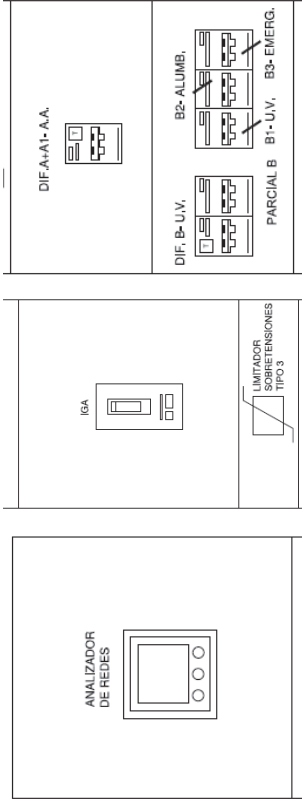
Esquema Unifilar Tipo Cuadro Eléctrico Secundario de planta
